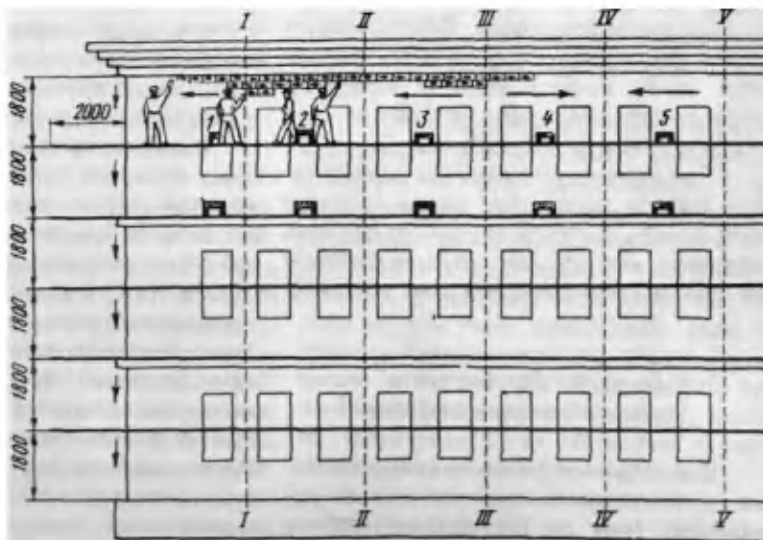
Оштукатуривание фасада горизонтально расположенными захватами
